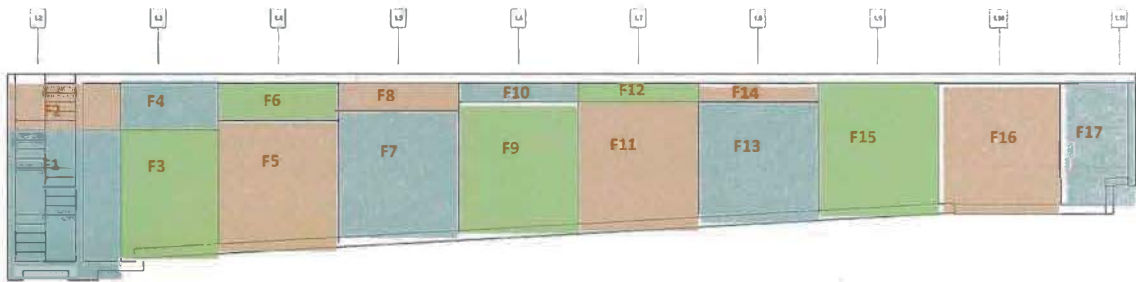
Sectorización muros faja 5 -Eje B (Fuente propia)
